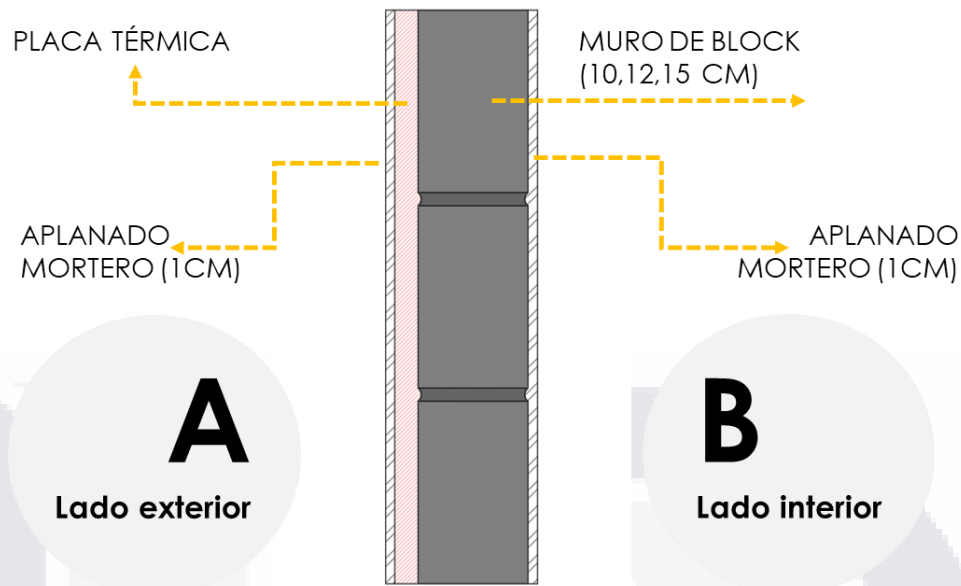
Detalle para fabricación de muros con recubrimiento térmico. Fuente: autoría propia
